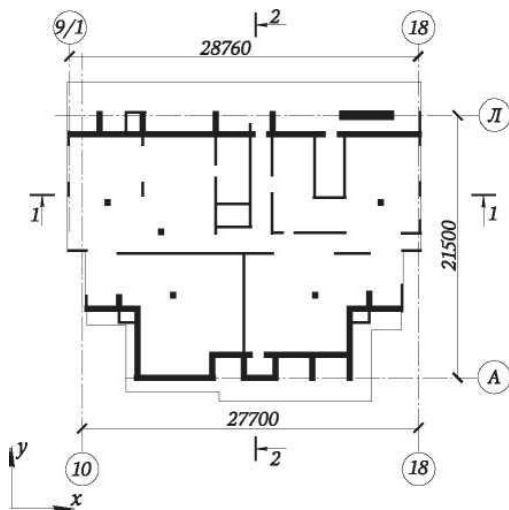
Схема розташування фундаментної плити, стін і колон підвалу
